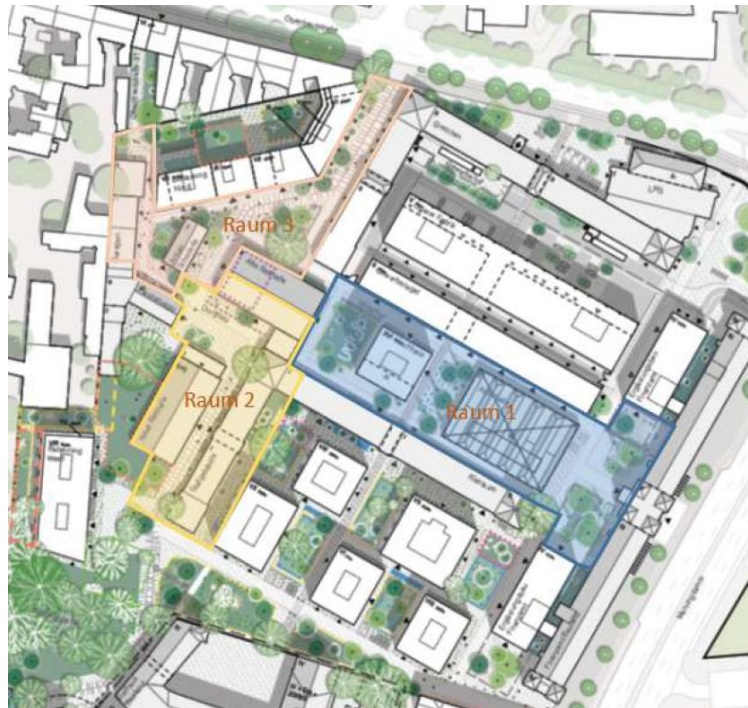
3 Betrachtungsräume (Plangrundlage Freiraumkonzept SMAQ/MML. 2022)
